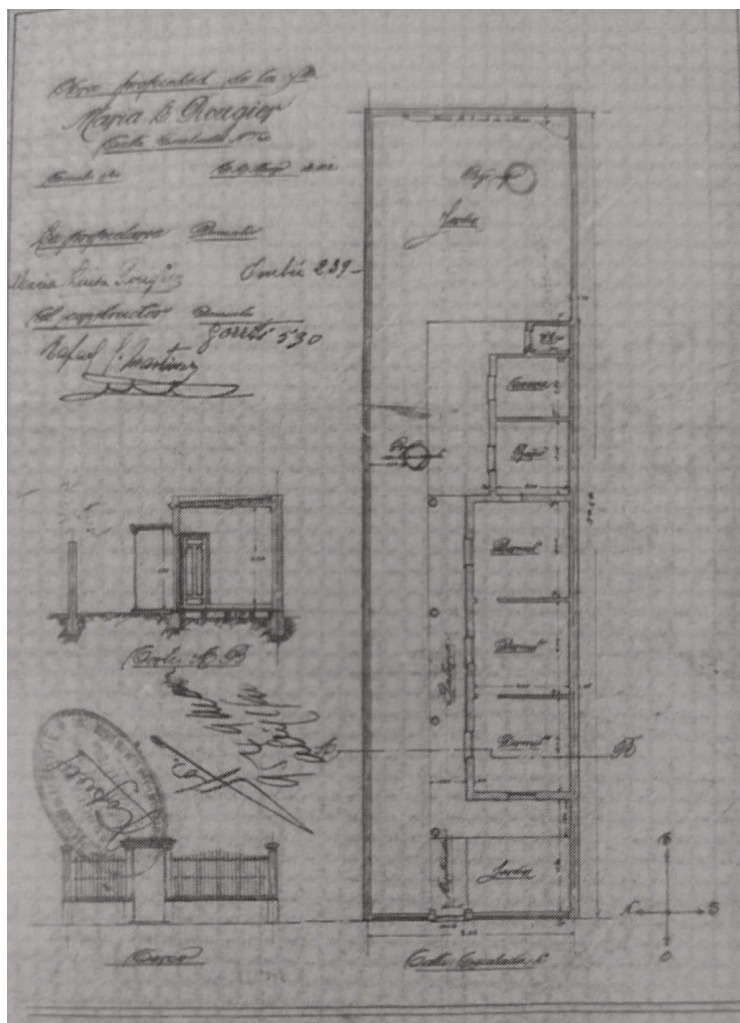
Plano de la vivienda tipo “chorizo” de tres habitaciones construida en la calle Escalada en el actual barrio de Villa Luro, 1907. Fuente: extraída de Dunowicz y Villaveirán (2013).
